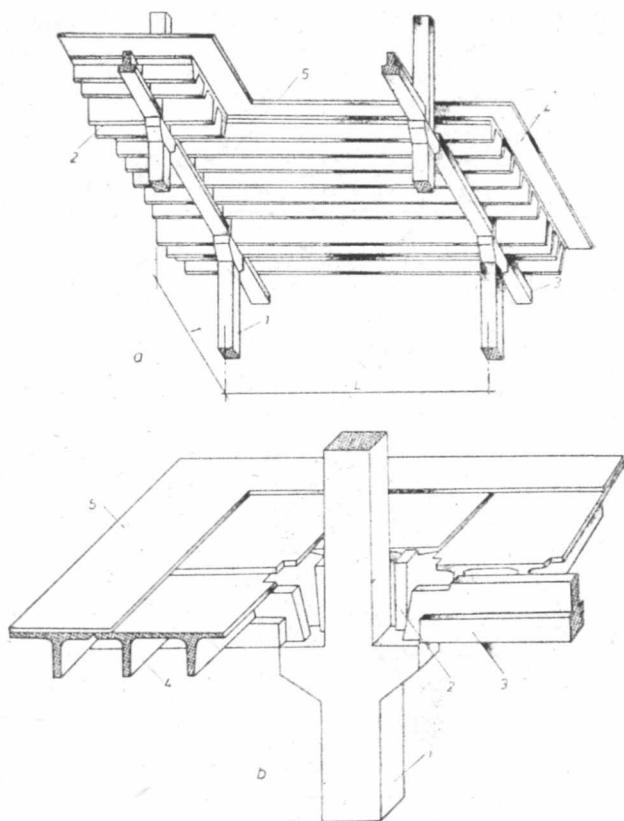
Elementele structurii integral prefabricate — varianta stâlpi cu console scurte — pentru hale industriale etajate :
